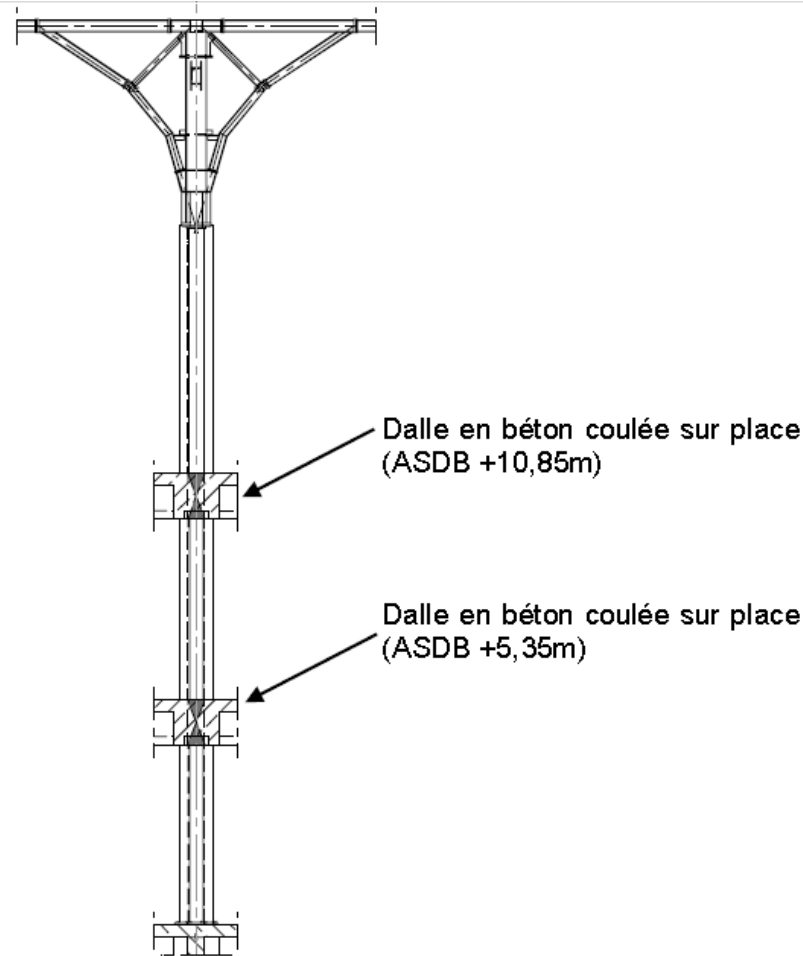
Structure d'un poteau de diamètre 81cm – Type n° 4
